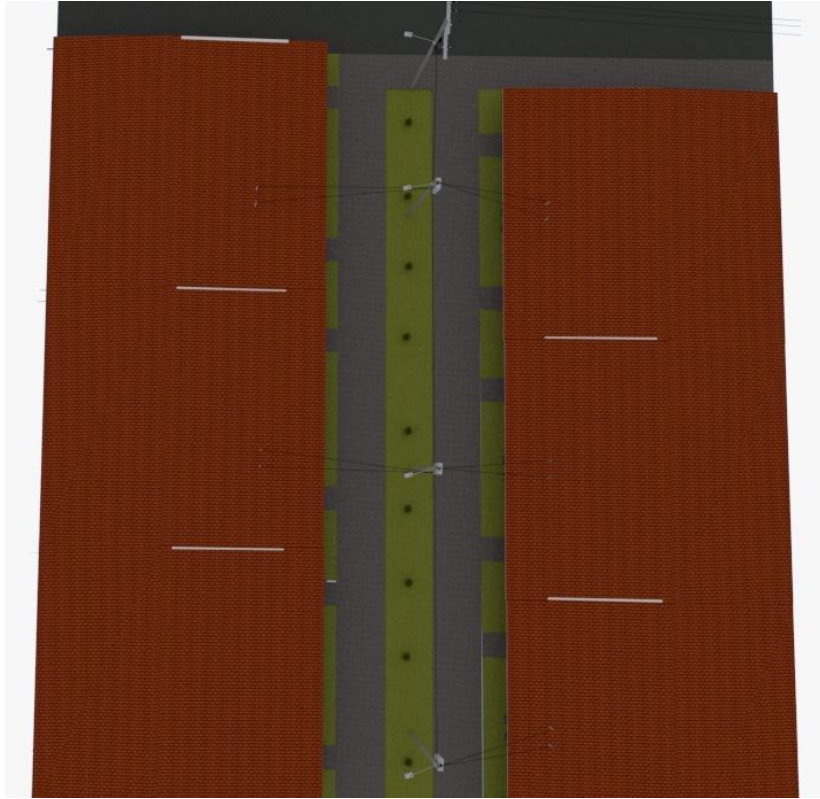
Vista 3D en planta viviendas portal de las ferias. (Fuente: elaboración propia)
